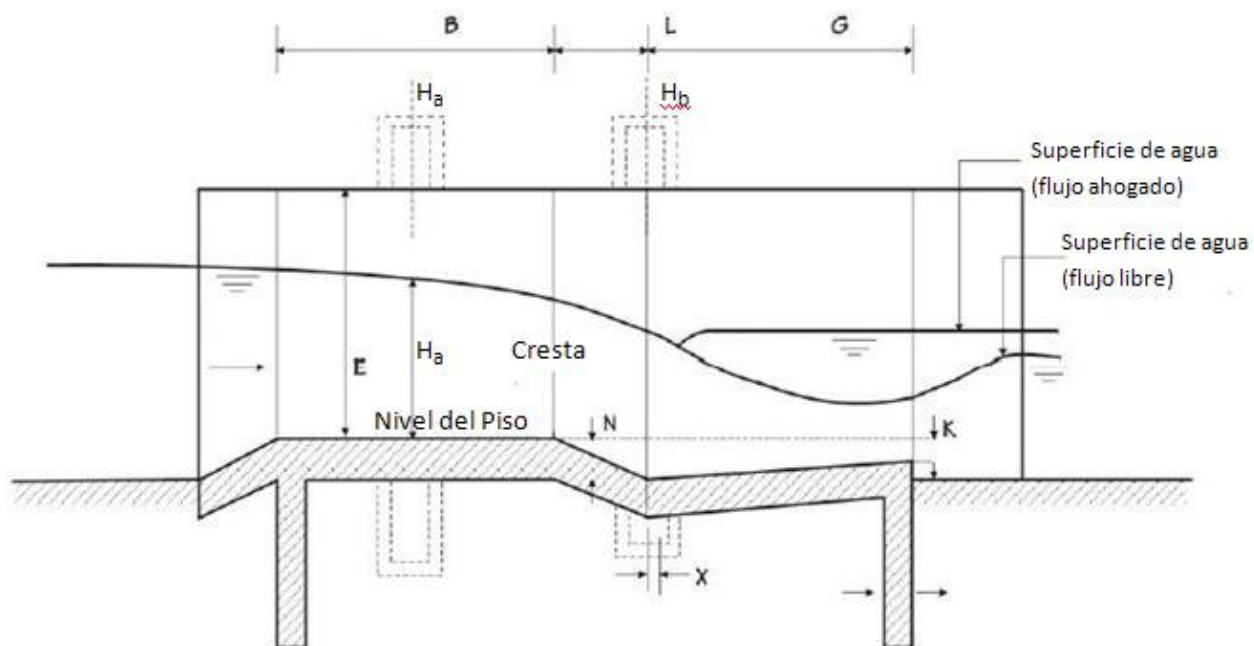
Dimensiones en perfil para las Canaletas Parshall
